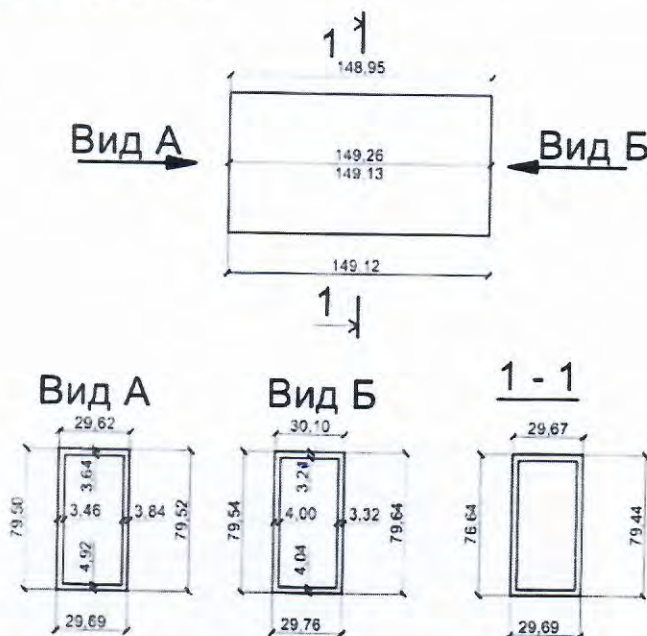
Геометрические размеры стеклопластикового образца коробчатого профиля, измеренные при его испытании
